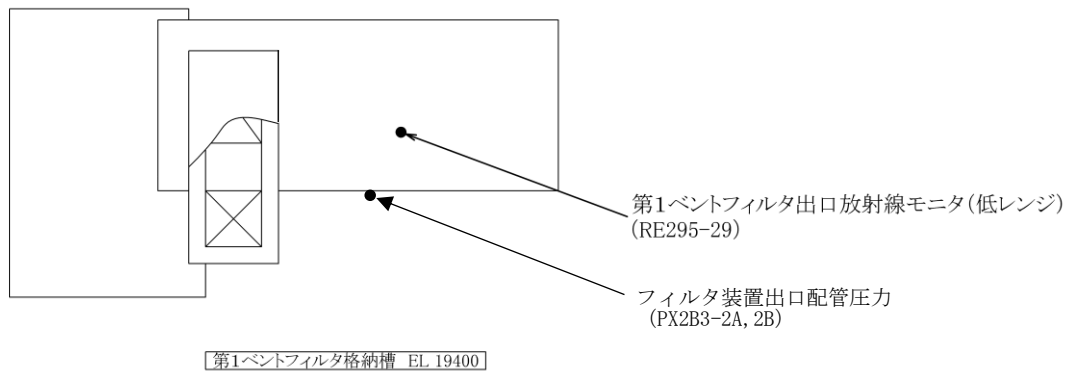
機器配置図 (第1ベントフィルタ格納槽) (1/3)
